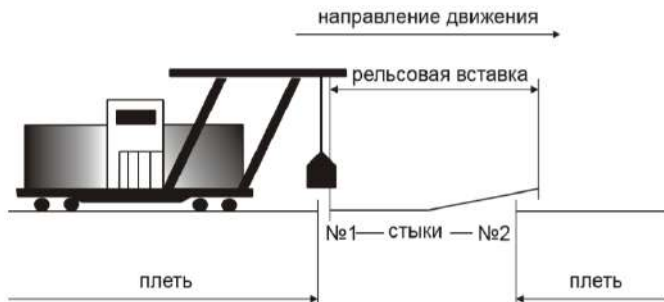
Схема расположения ПРСМ и рельсовой вставки в месте сварки
